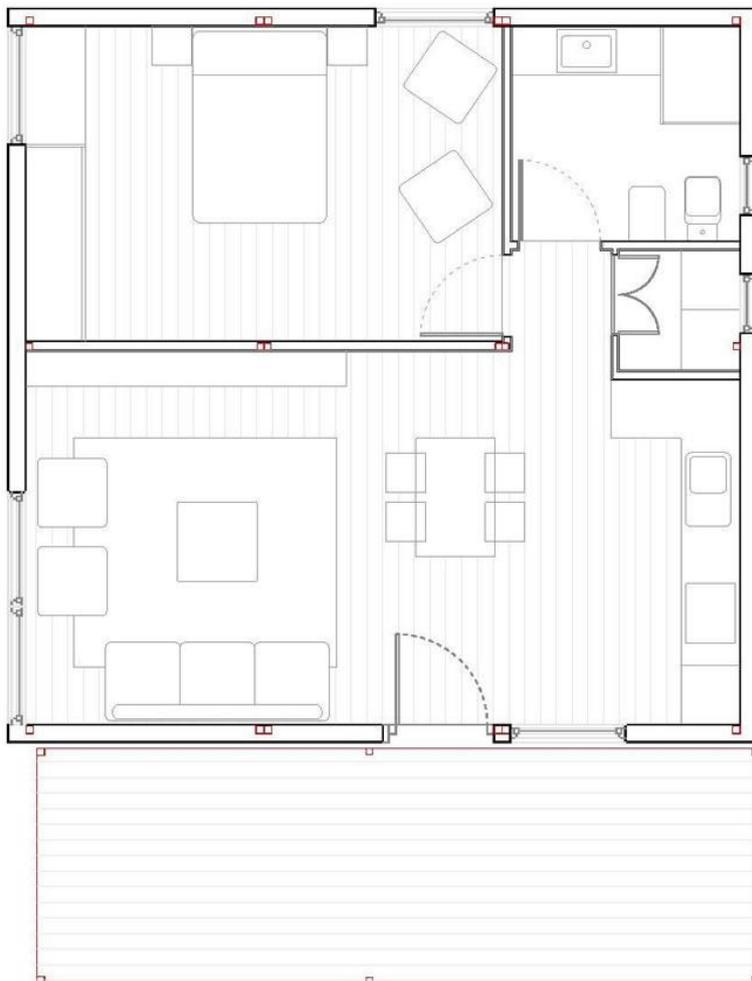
Plano Vivienda modular 1 dormitorio HOME3
